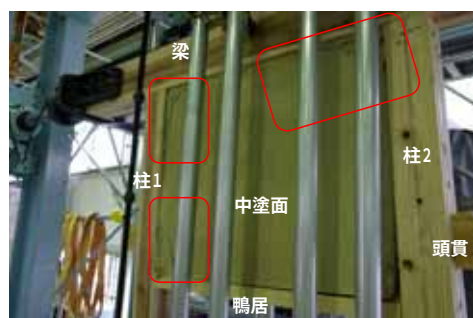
中塗り側 最終加力時1/20rad 隅角部のひび割れ
